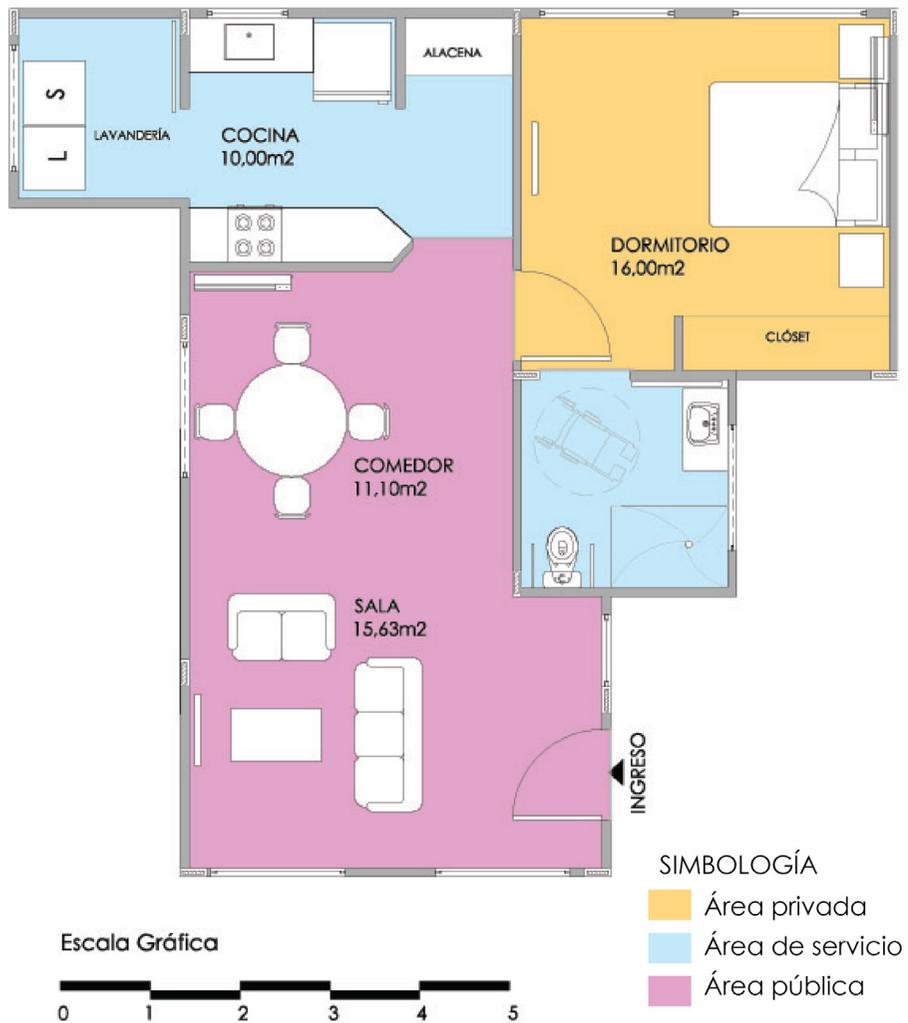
Planta arquitectónica tipo y zonificación de apartamento individual tipología I. Elaboración propia.
